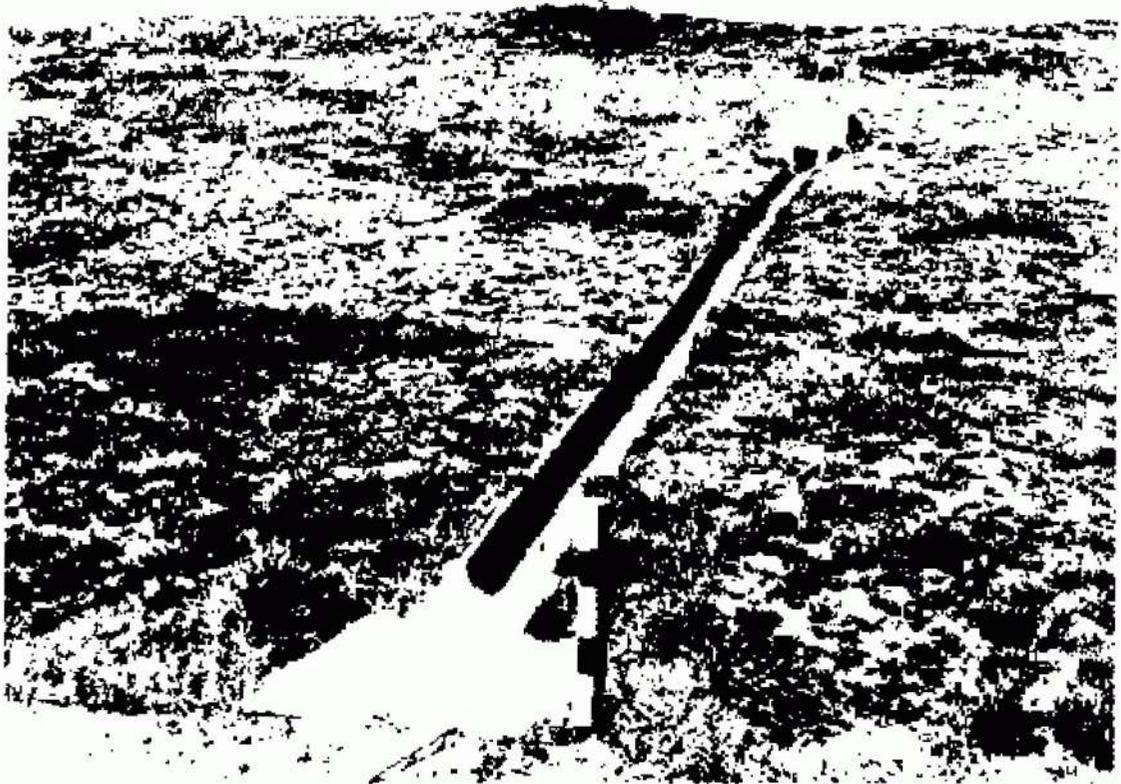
Canaletas de drenagem. Fonte: CORPUS.
